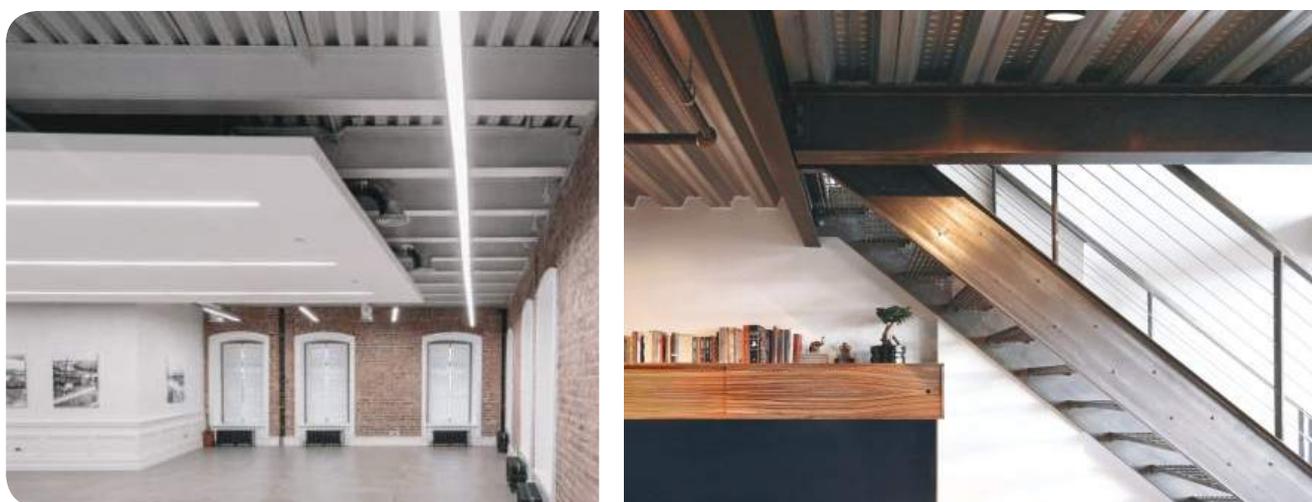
Перекрытия с плитами по профилированному настилу в интерьере помещений после реконструкции
